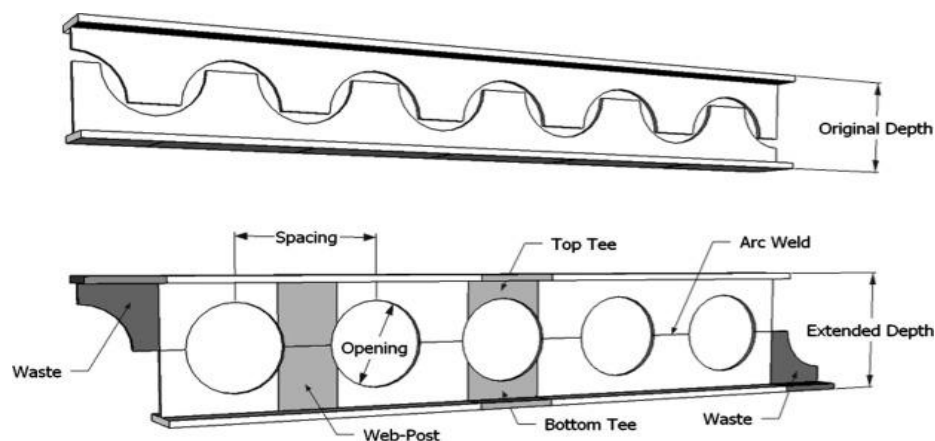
Partes de viga de acero de alma aligerada. A las vigas con este tipo de abertura se les conoce como vigas celulares
